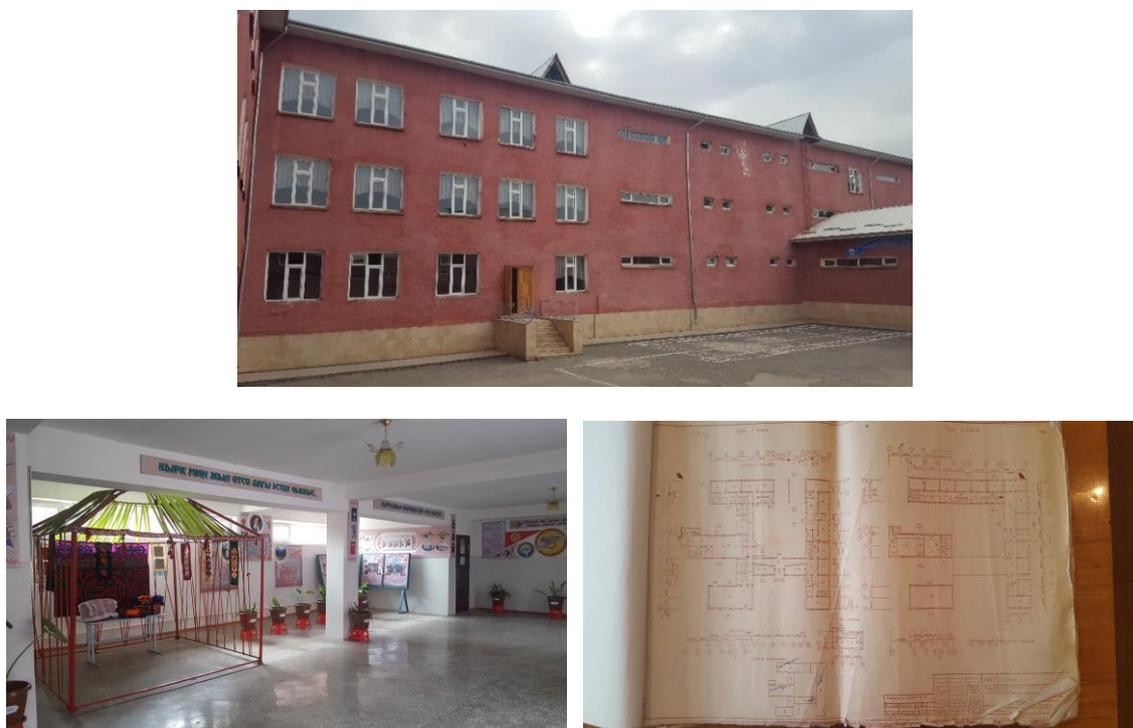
Здание школы из железобетонного каркаса с кирпичным заполнением, школа №21 им. А.С. Пушкина, г. Ош
